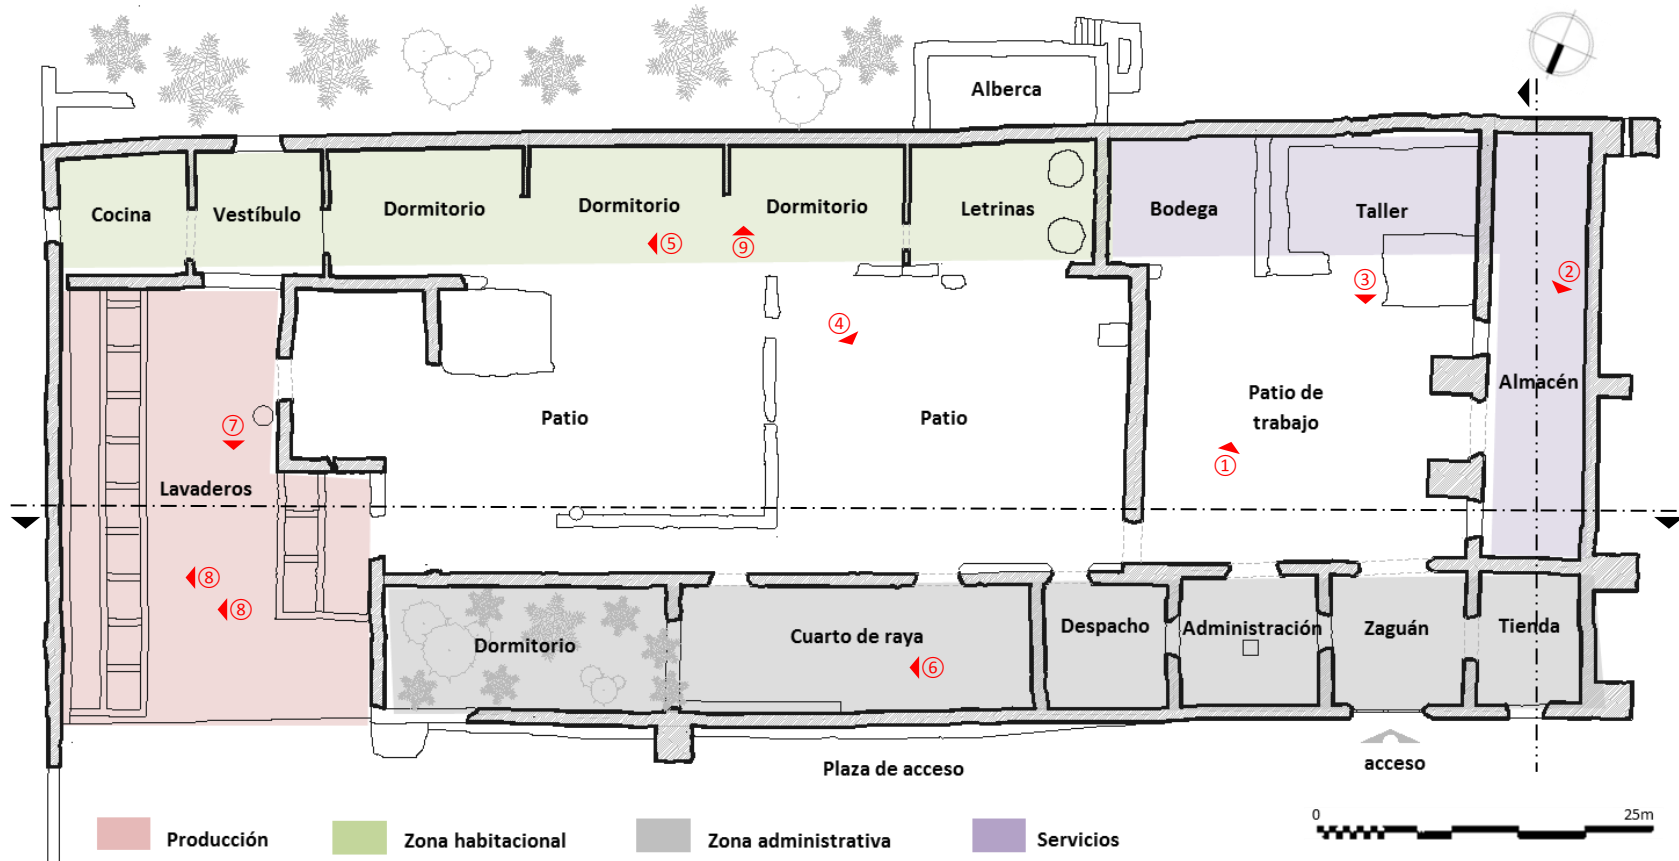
Planta arquitectónica, estado actual del casco principal. 2017. Ver anexo de planos EA_004.
